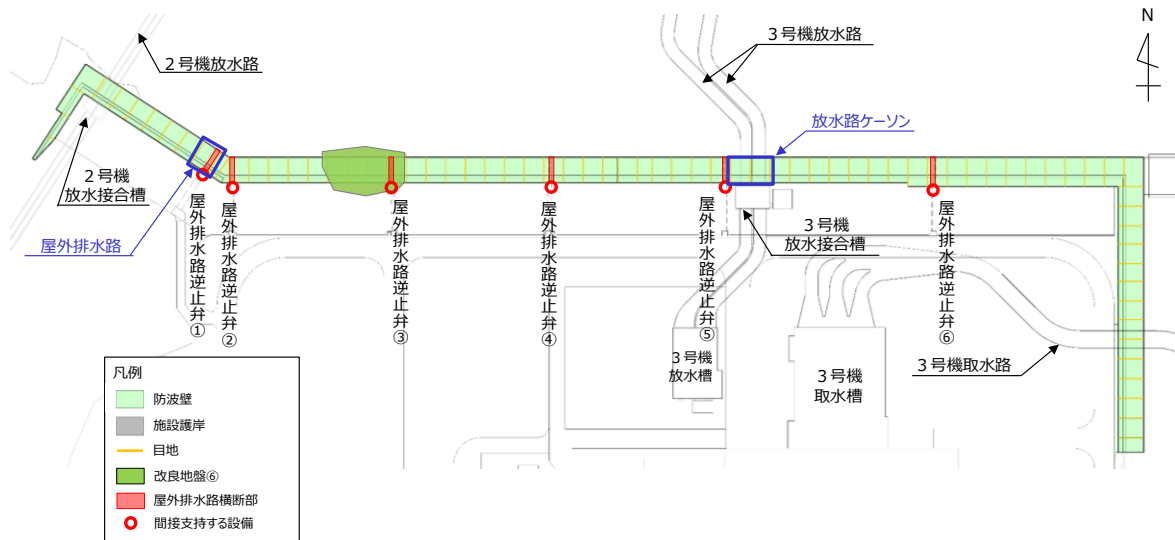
(1) 屋外排水路逆止弁①と接続する屋外排水路と放水路ケーソンの平面位置図
